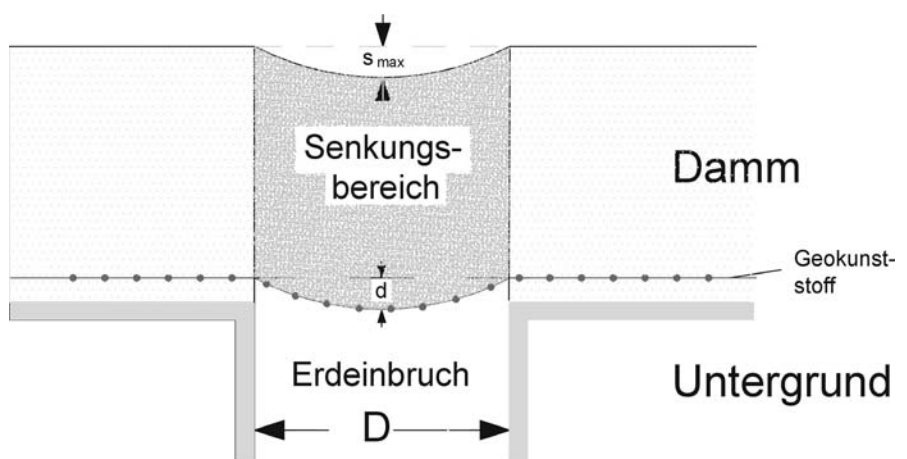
Anordnung einer Geokunststoffbewehrung zur Sicherung eines bruchgefährdeten Trassenbereiches
